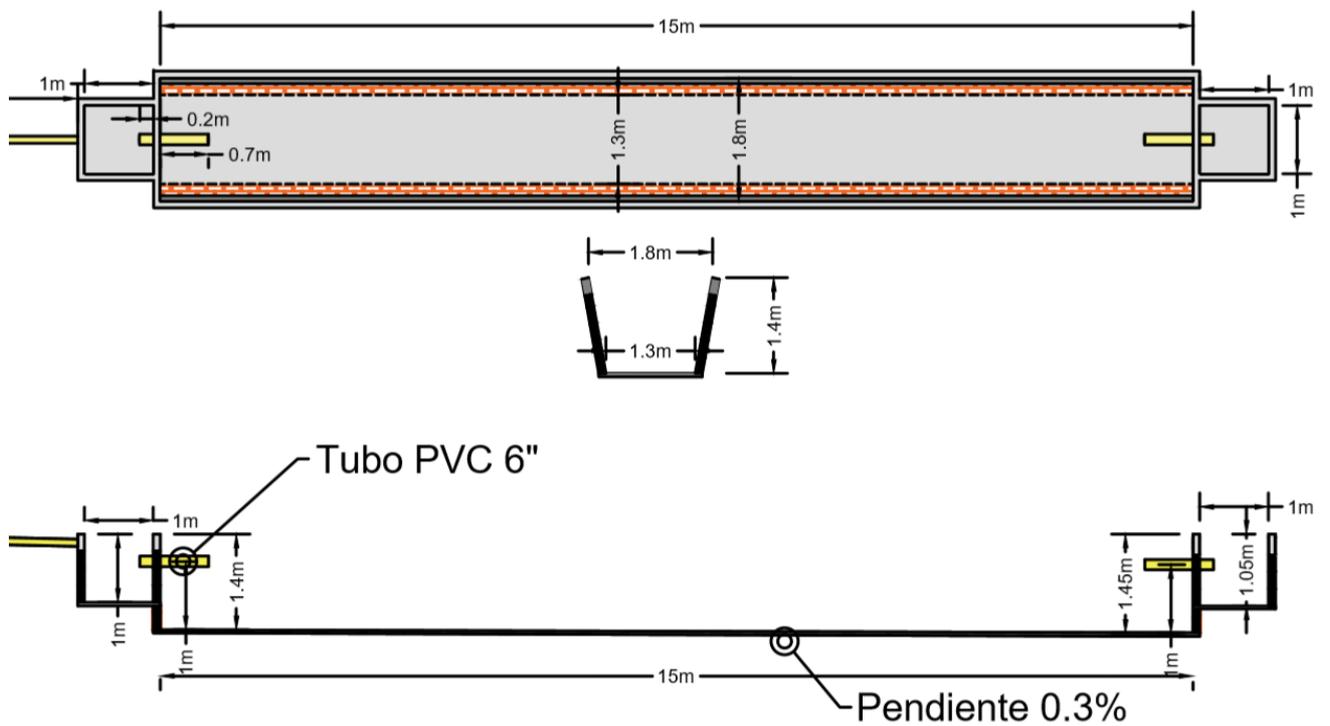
Diseño de tanque biodigestor con dimensiones en planta y corte.
